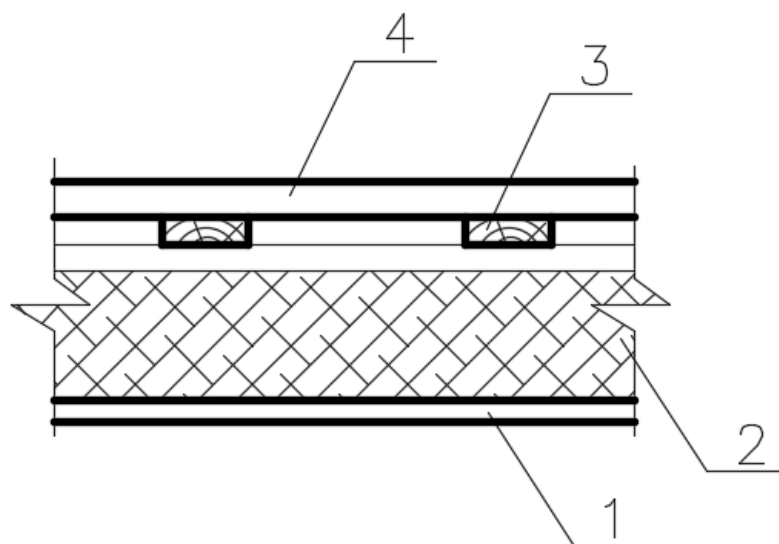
Конструкция покрытия мансардной кровли
